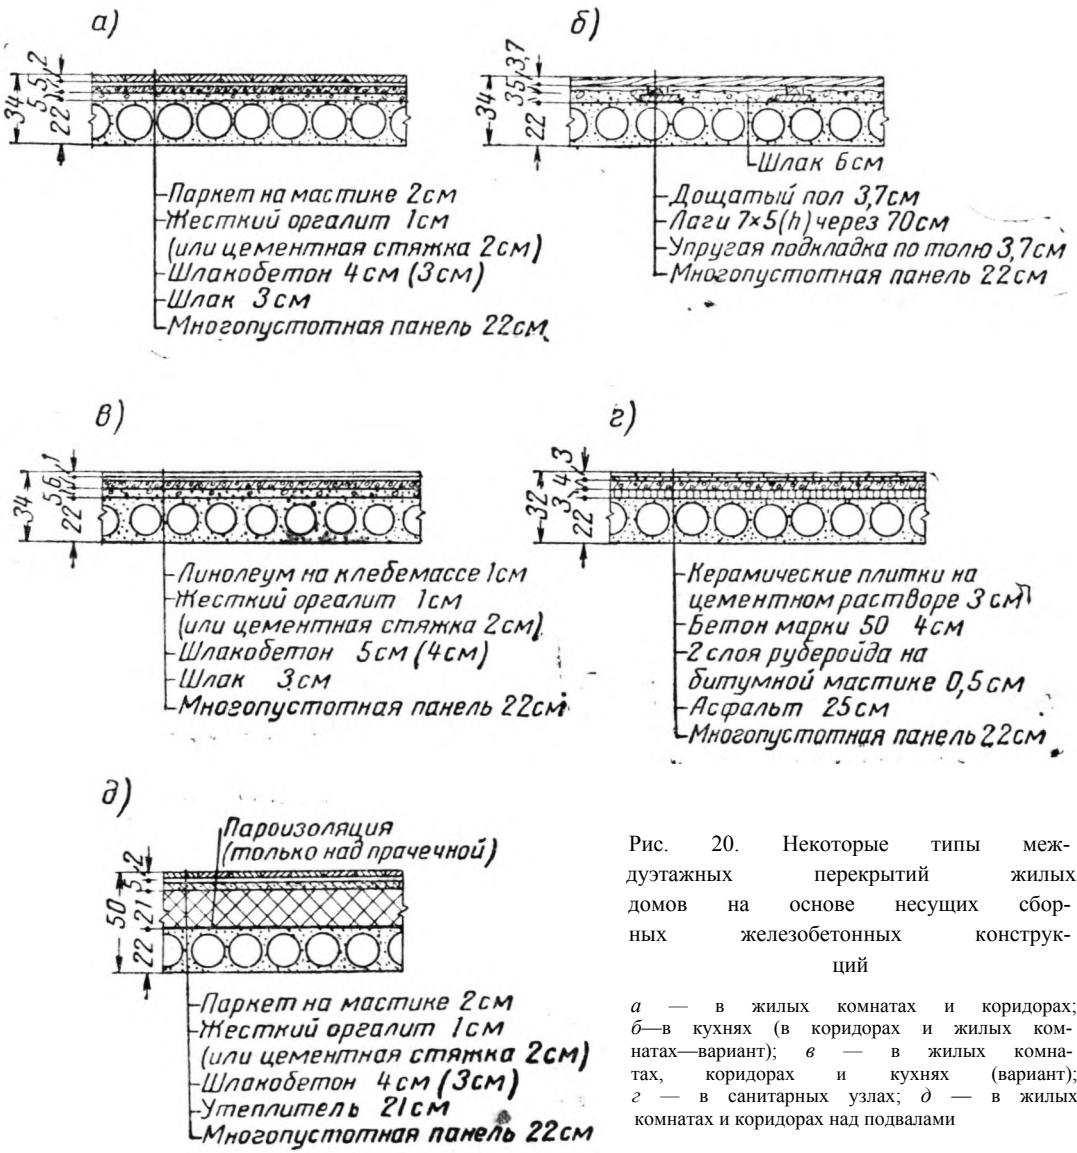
Некоторые типы междуэтажных перекрытий жилых домов на основе несущих сборных железобетонных конструкций
